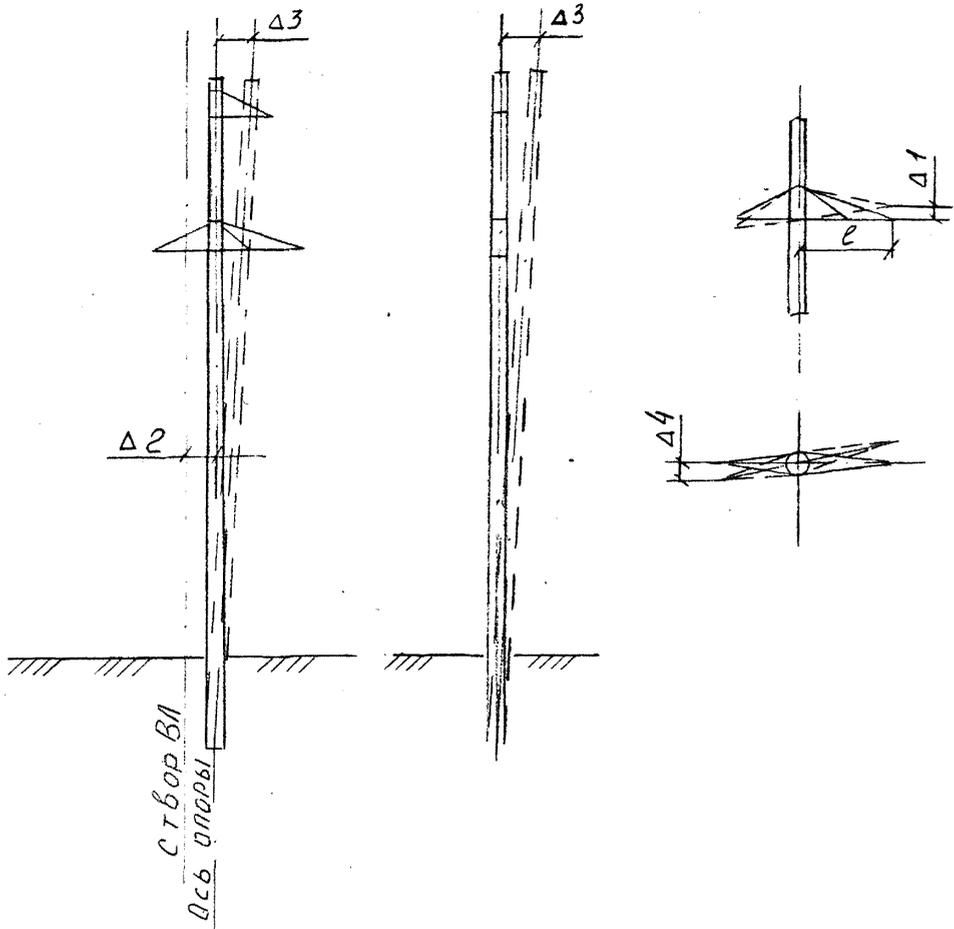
Допуски на сборку, установку опор с натяжками
